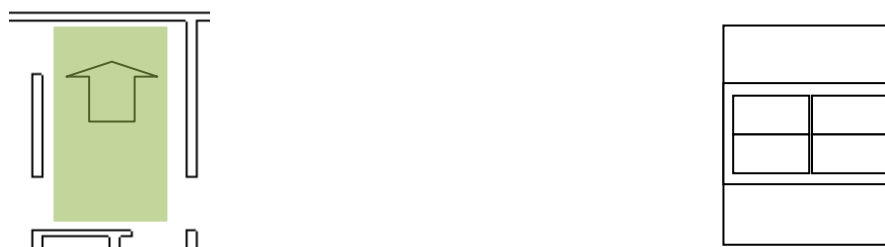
Módulo Técnicas Construtivas. Planta baixa e elevação esquemática da parede 02.
